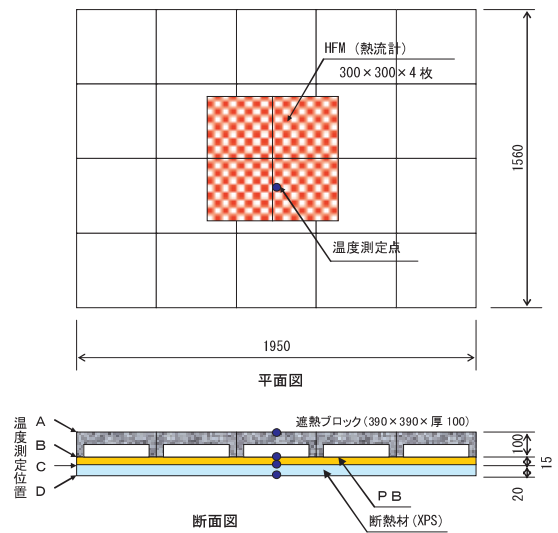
屋根モデルの構造・寸法 (寸法単位: mm)
